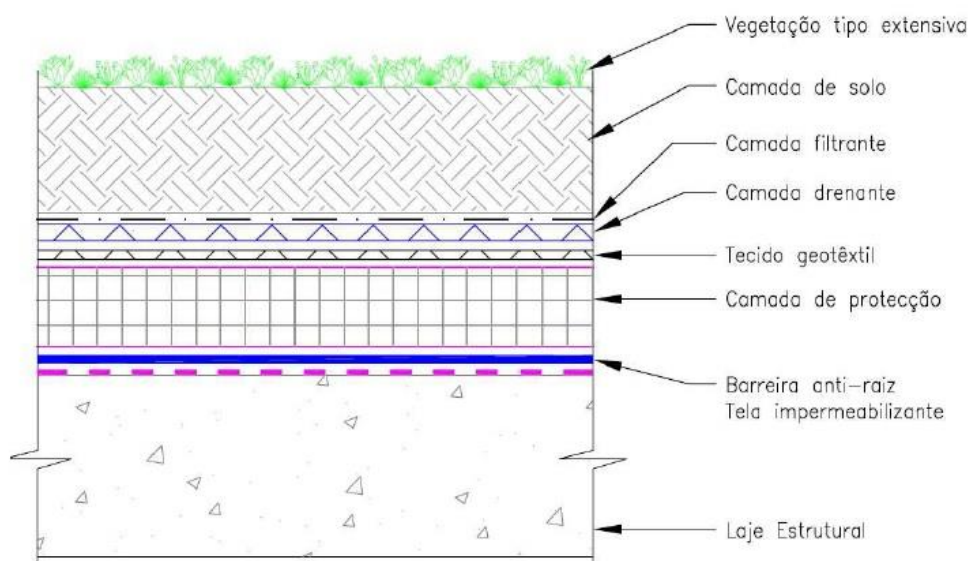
Pormenor construtivo de uma cobertura jardim extensiva (Ferreira 2013)
